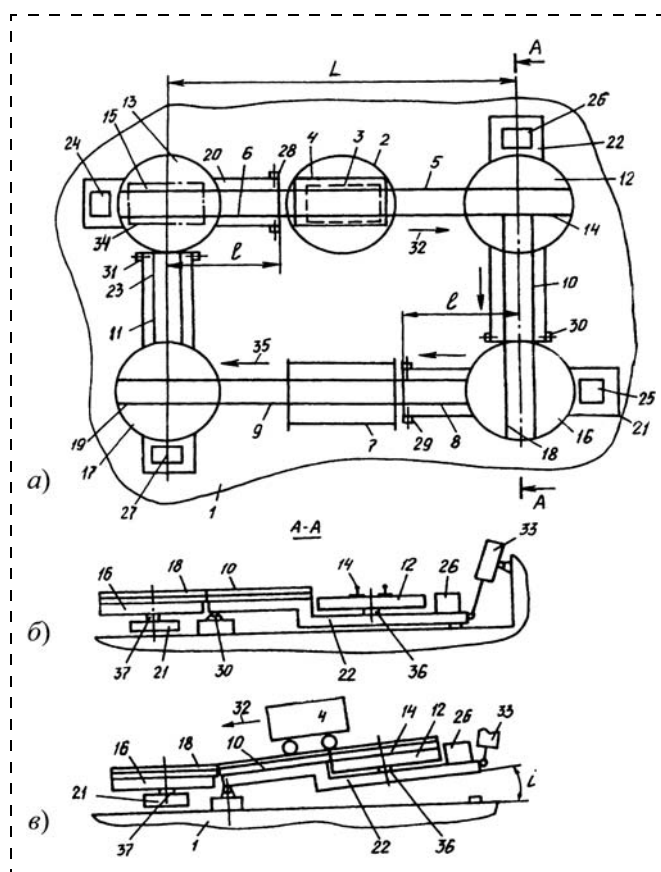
Приемная площадка надшахтного здания по второму варианту: а — план перекрытия с расположением оборудования, соответствующим моменту, предшествующему выкатыванию грузовой вагонетки из клетки; б — разрез А-А при расположении рамы с поворотным кругом и первым дополнительным рельсовым путем в момент приема грузовой вагонетки на поворотный круг; в — то же, в момент самокатного движения вагонетки
